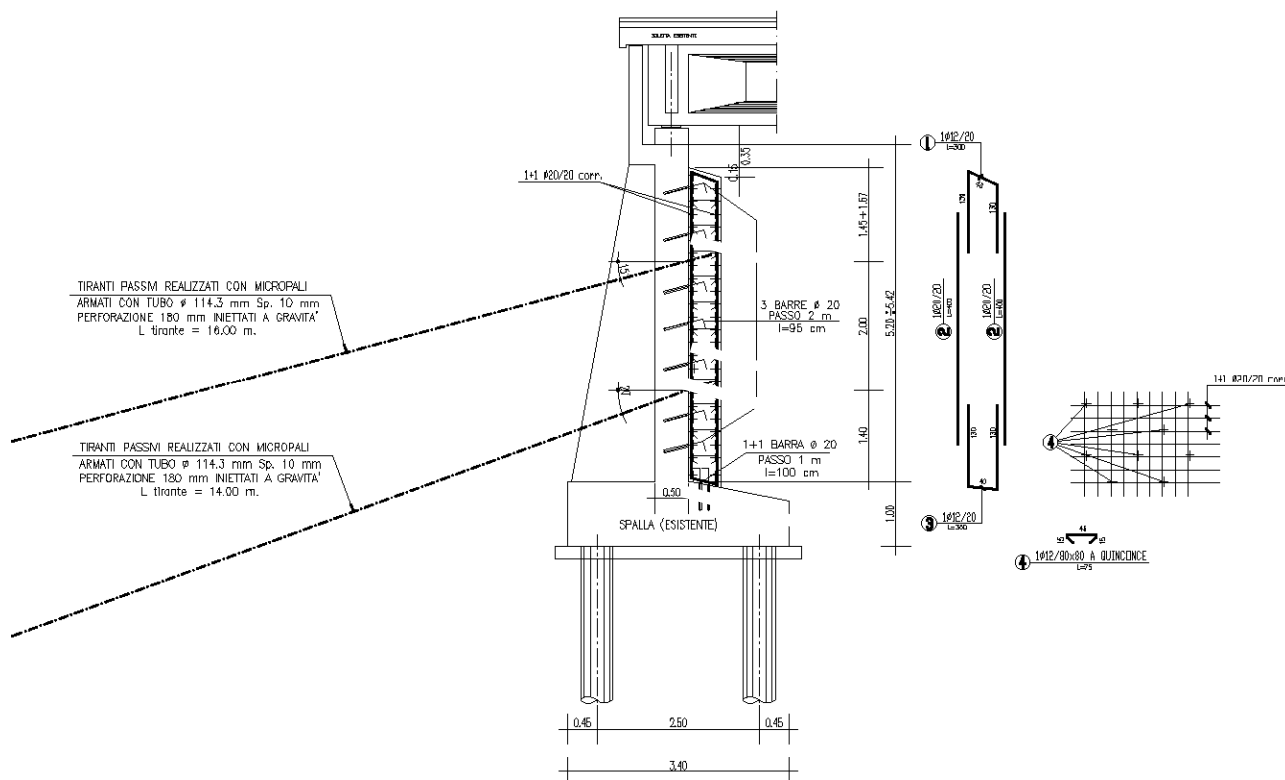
Spalle – Sezione rinforzo strutturale realizzato
